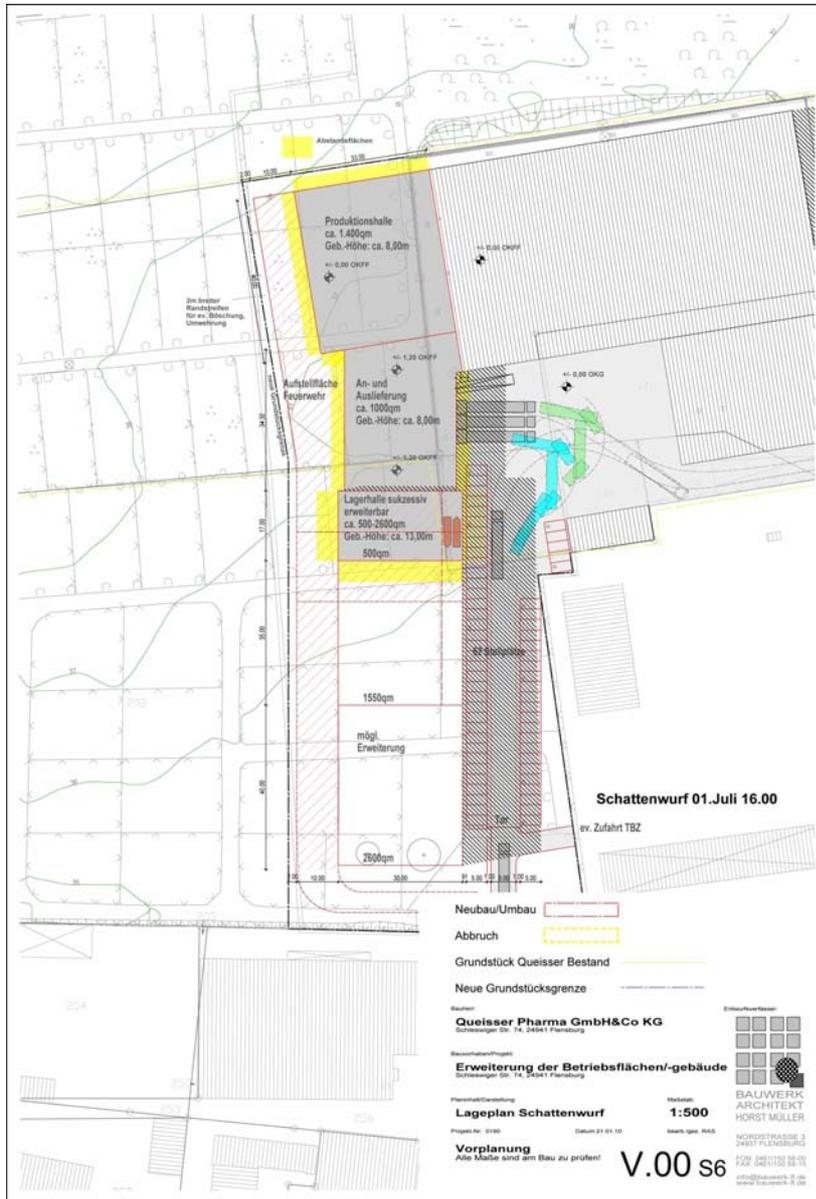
Lageplan des geplanten Gebäudes mit Schattenwurf im Juli um 16.00 Uhr.
